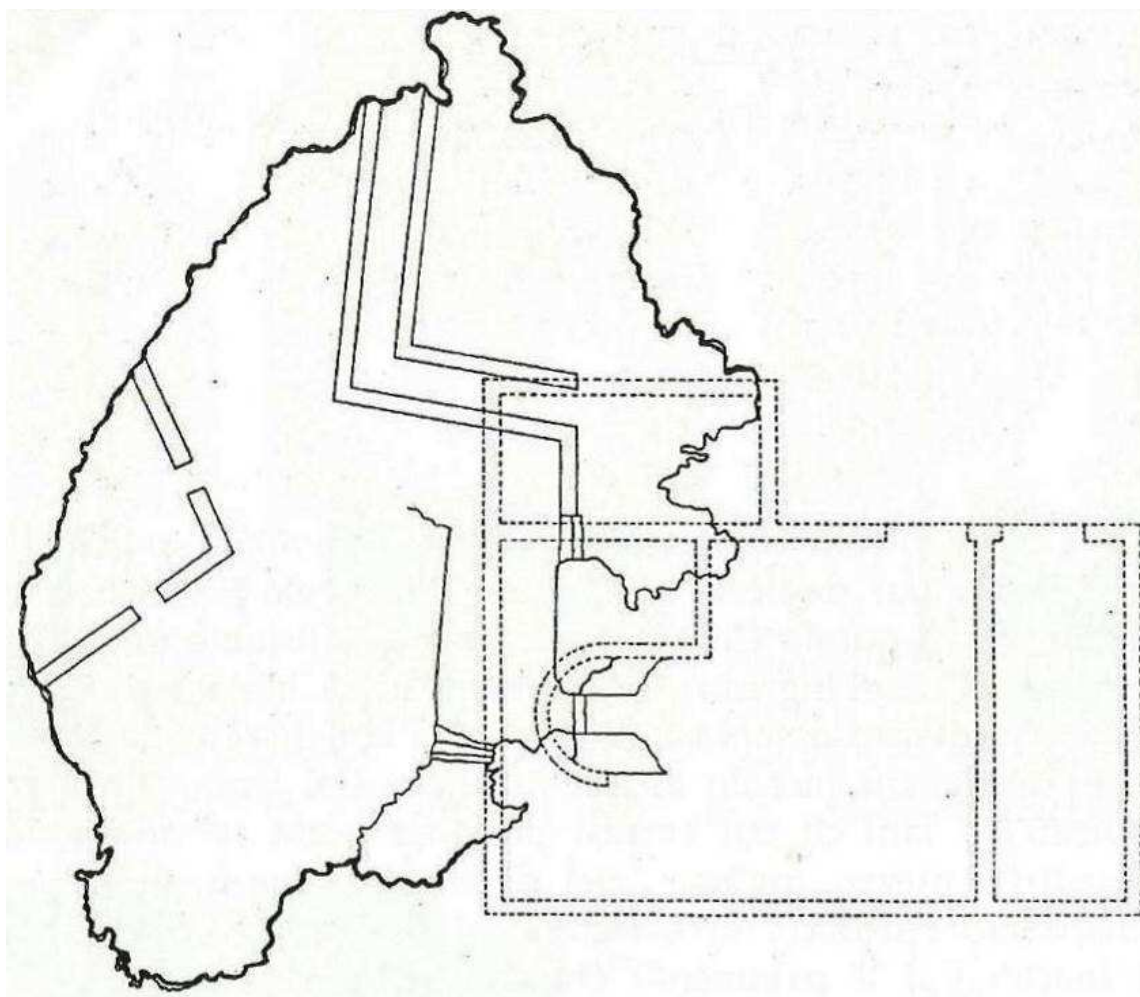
Grotta di San Michele a Sala Consilina. Schema planimetrico. Cerenza A., *op. cit.*, p. 160
